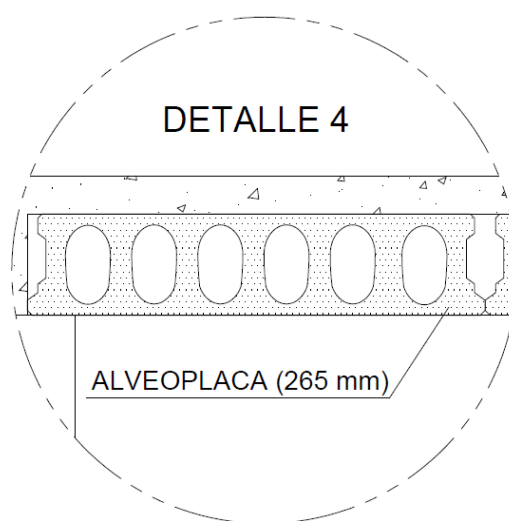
Detalle de la placa alveolar, extraído del *Plano 3.1*.
